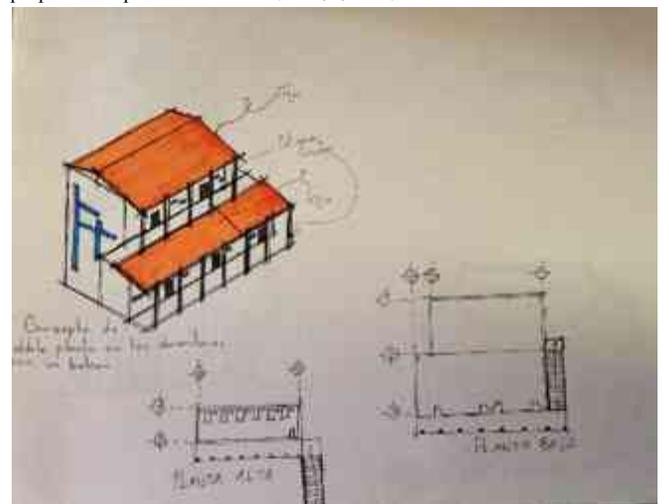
“Propuesta del comedor y cocina de dos plantas, perspectiva y plantas.”
